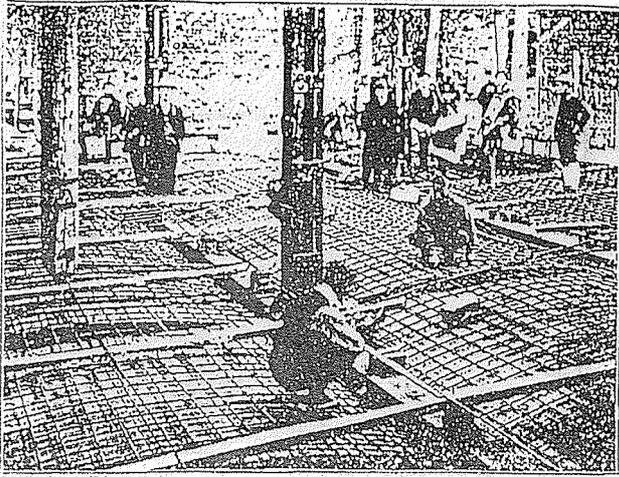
京都商品陳列所の床構造施工状況²¹⁾
